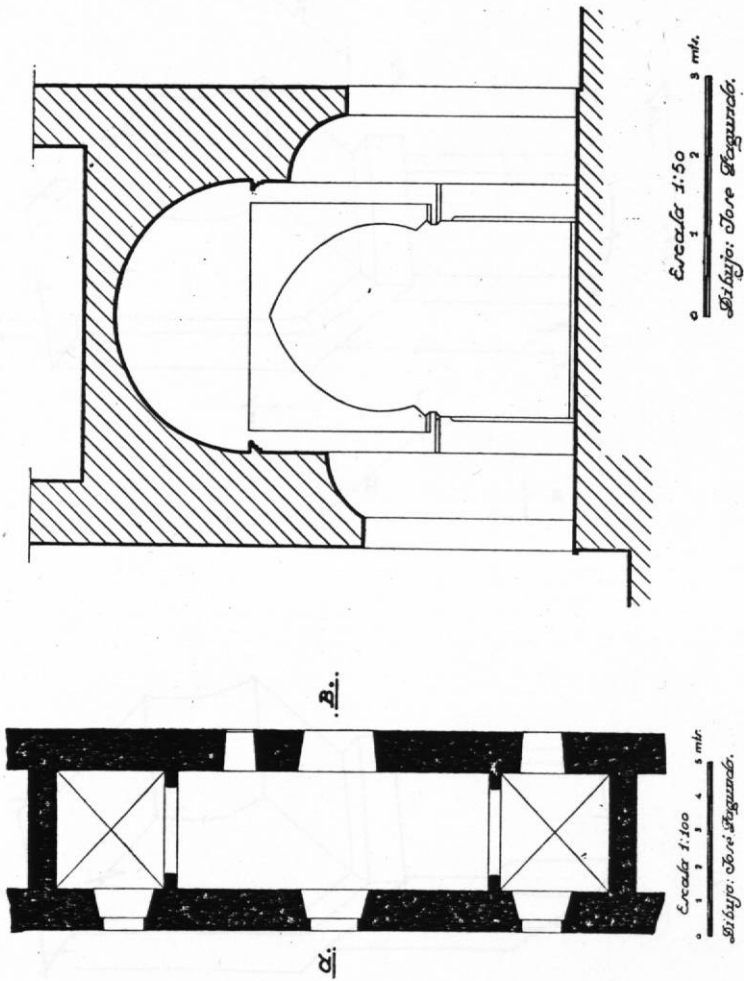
Planta y sección existente en el Catálogo Arqueológico.
